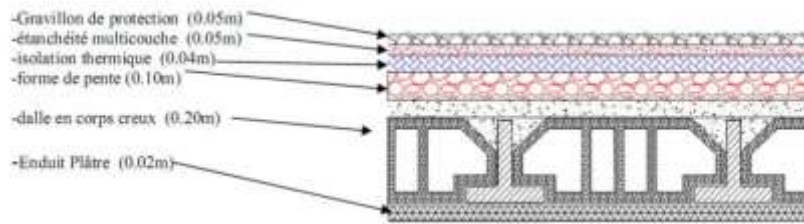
Schéma d'un plancher terrasse inaccessible.
